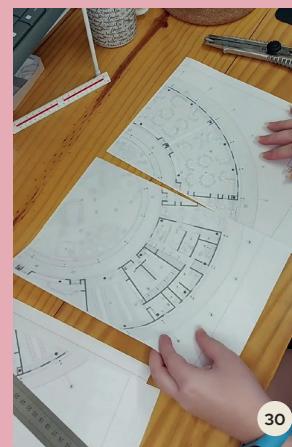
Corte dos pilares. Fonte: Acervo pessoal.
